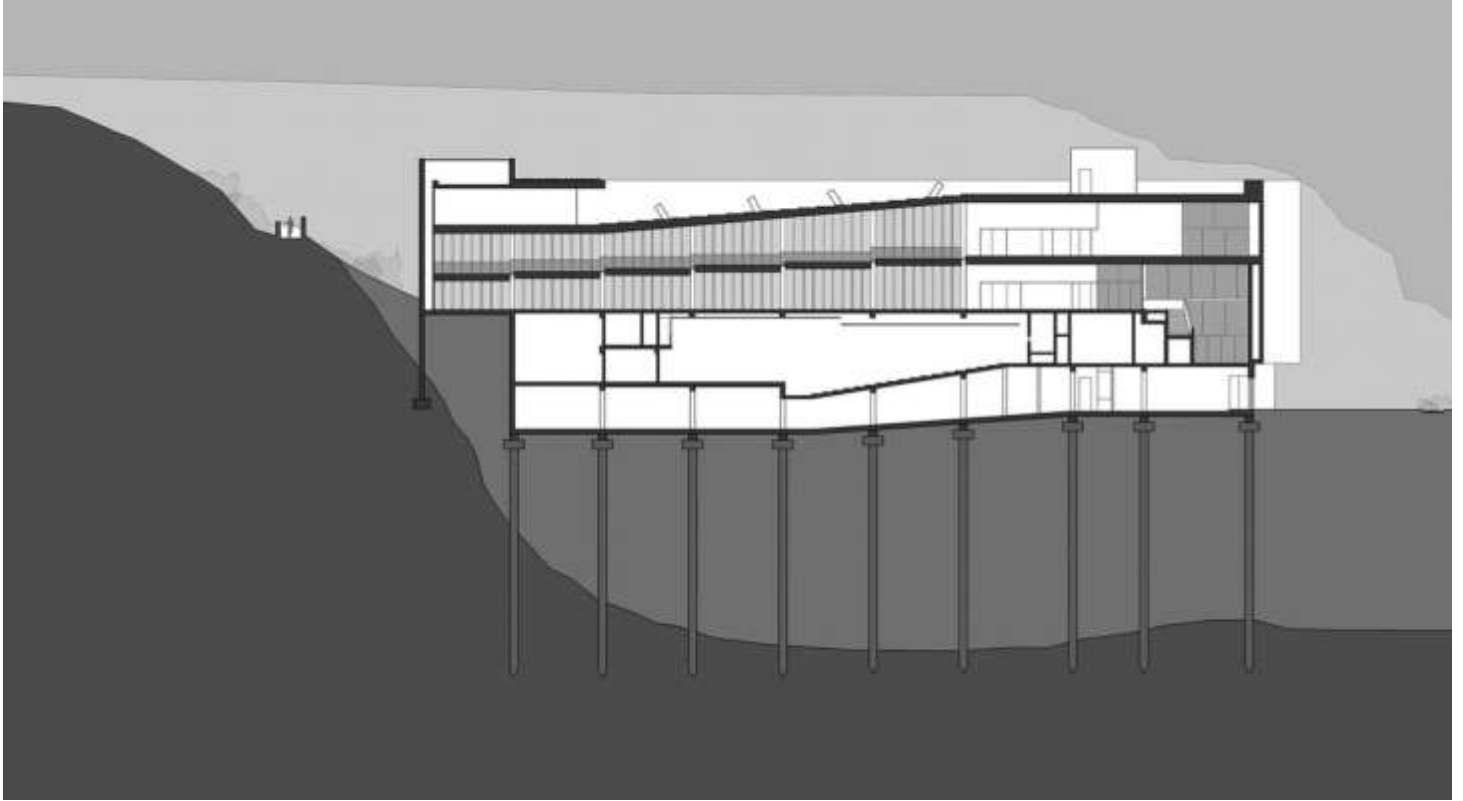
LUM. Corte longitudinal. Estudio Barclay & Crousse
